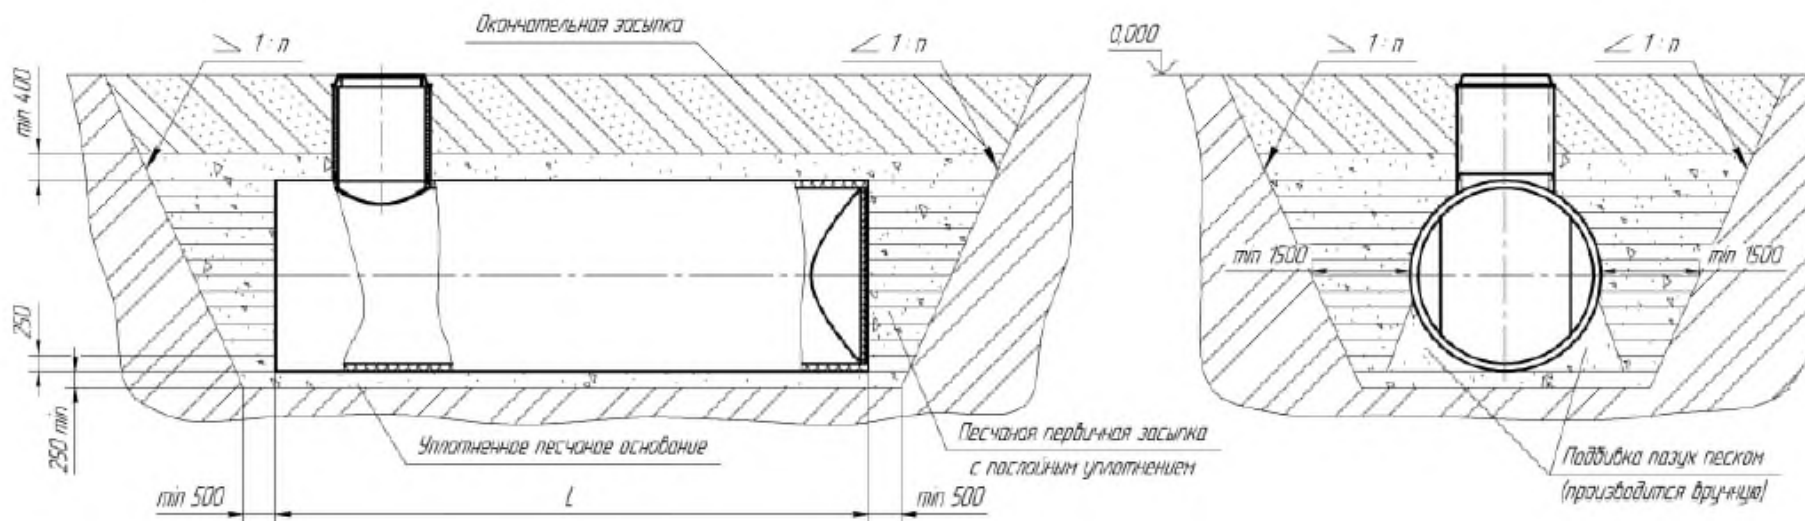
Вариант №1 (монтаж в сухих грунтах на уплотненное песчаное основание)
